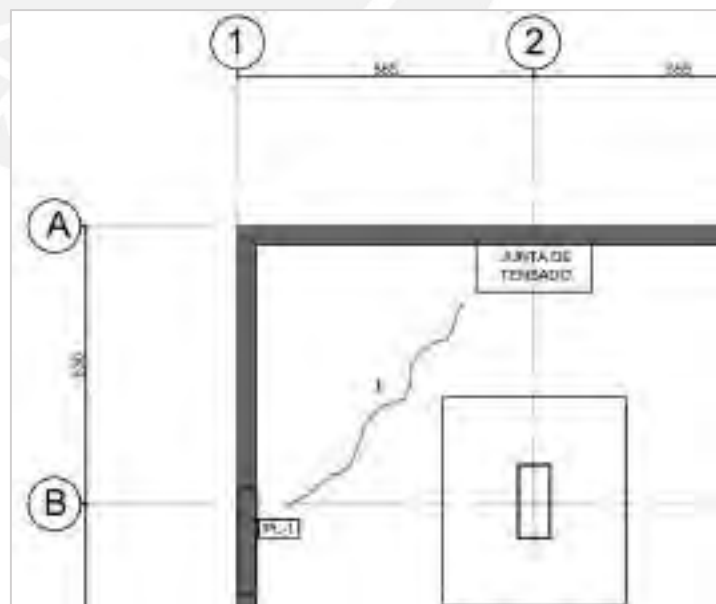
Fisura 1 ubicada en la losa del sótano 2.
